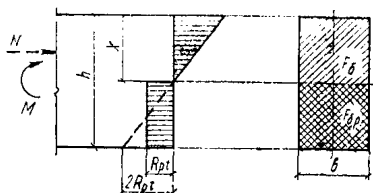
Схема усилий и эпюра напряжений в сечении, нормальном к продольной оси изгибаемого (внецентренно-сжатого) бетонного элемента, рассчитываемого с учетом сопротивления бетона растянутой зоны
